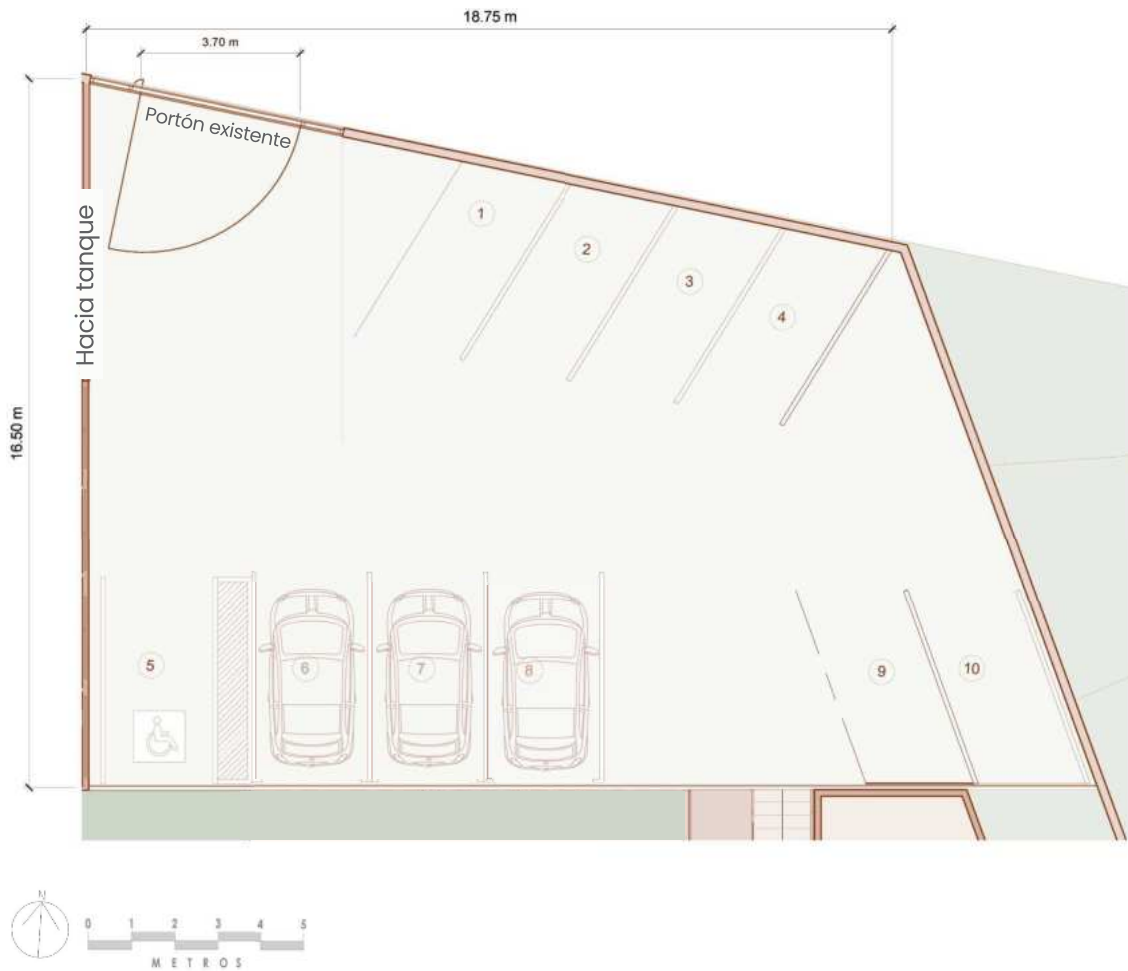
Planta arquitectónica de Parqueo | Fuente: Elaboración propia
